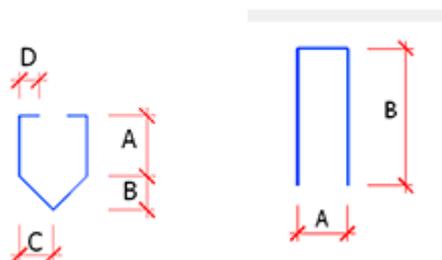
tipos de armaduras de rasante viga-losa.
